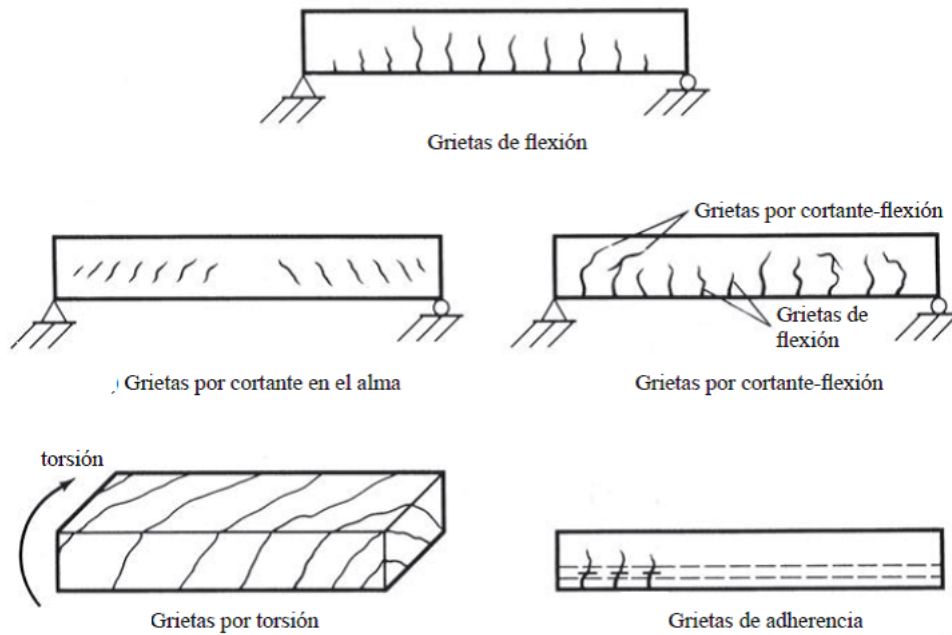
Algunos tipos de grietas en miembros de concreto.
